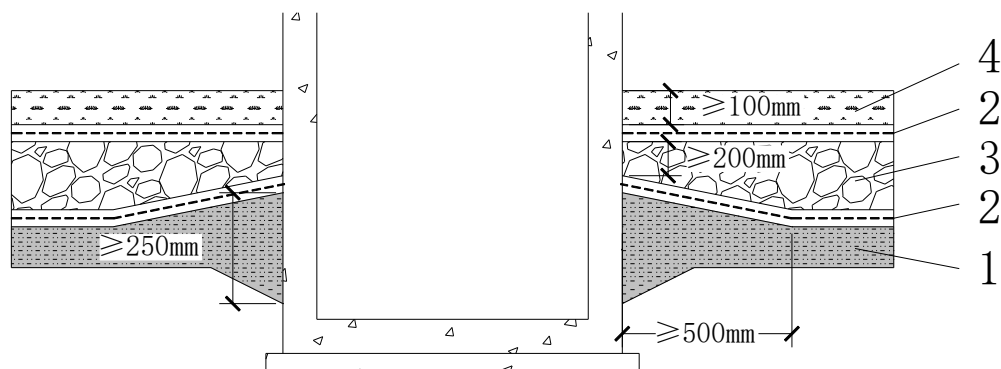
5. 2-1 地面与混凝土池壁衔接设计示意图
